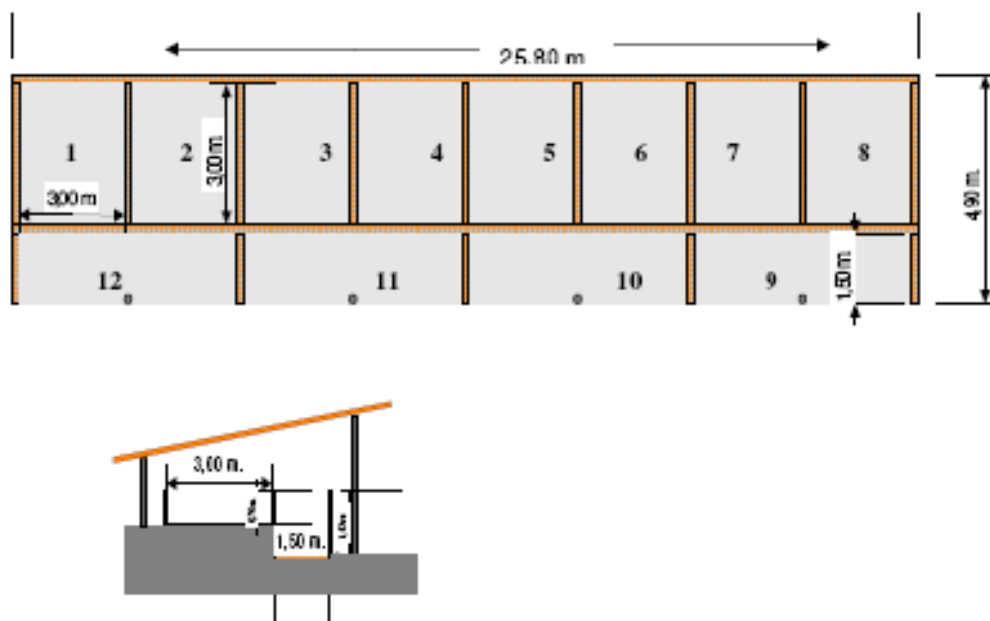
Planta baixa e corte das construções das câmaras de incorporação e compostagem. Fonte: Oliveira e Higarashi (2006)
